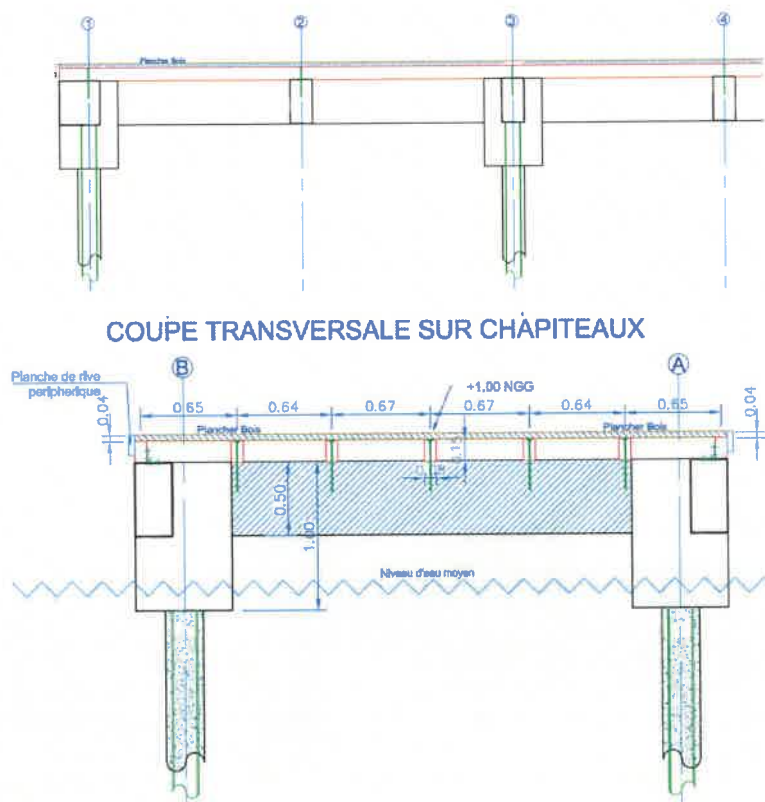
Coupe longitudinal et transversal du ponton (Extrait DOE de l'ouvrage existant)
